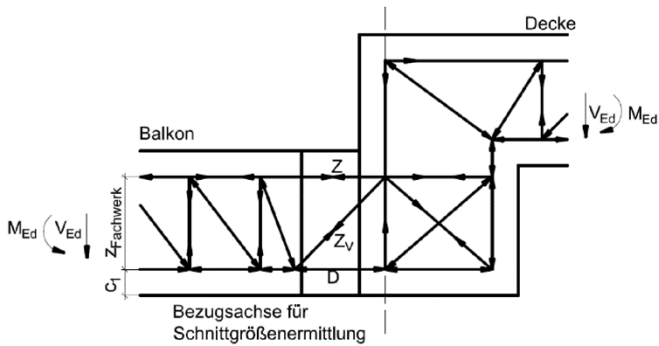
Schöck Isokorb® Typ K-U und K-U-F mit Anschluss an Höhenversatz
